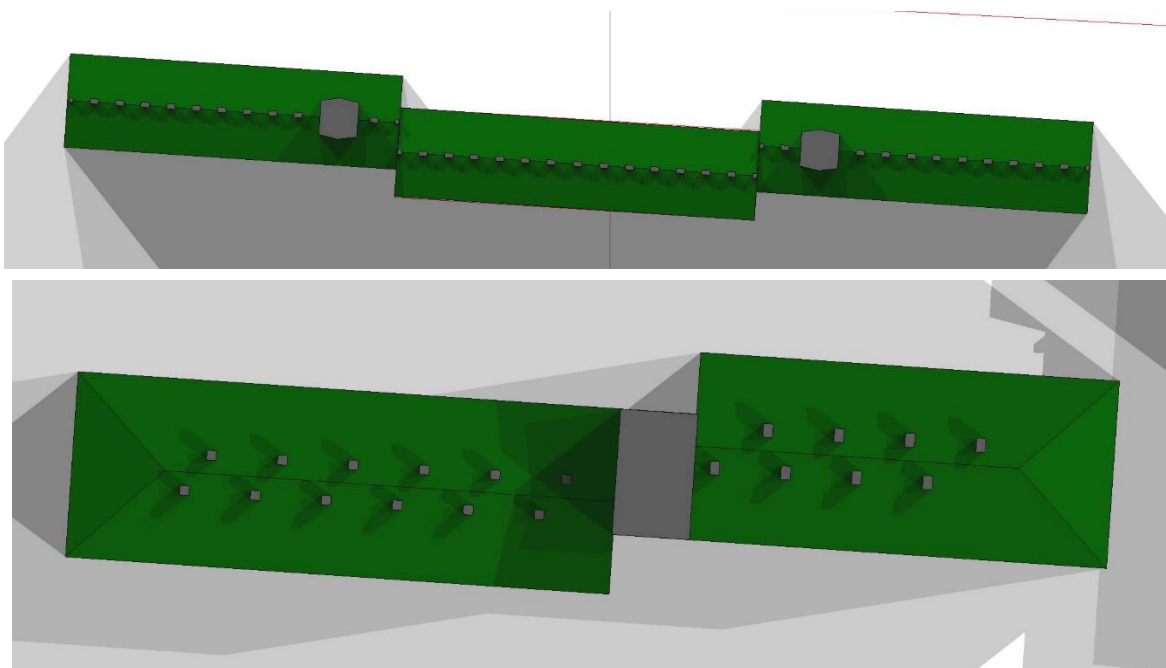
Vista con sombras superpuestas de las cubiertas en el día de diseño. (Elaboración propia)
